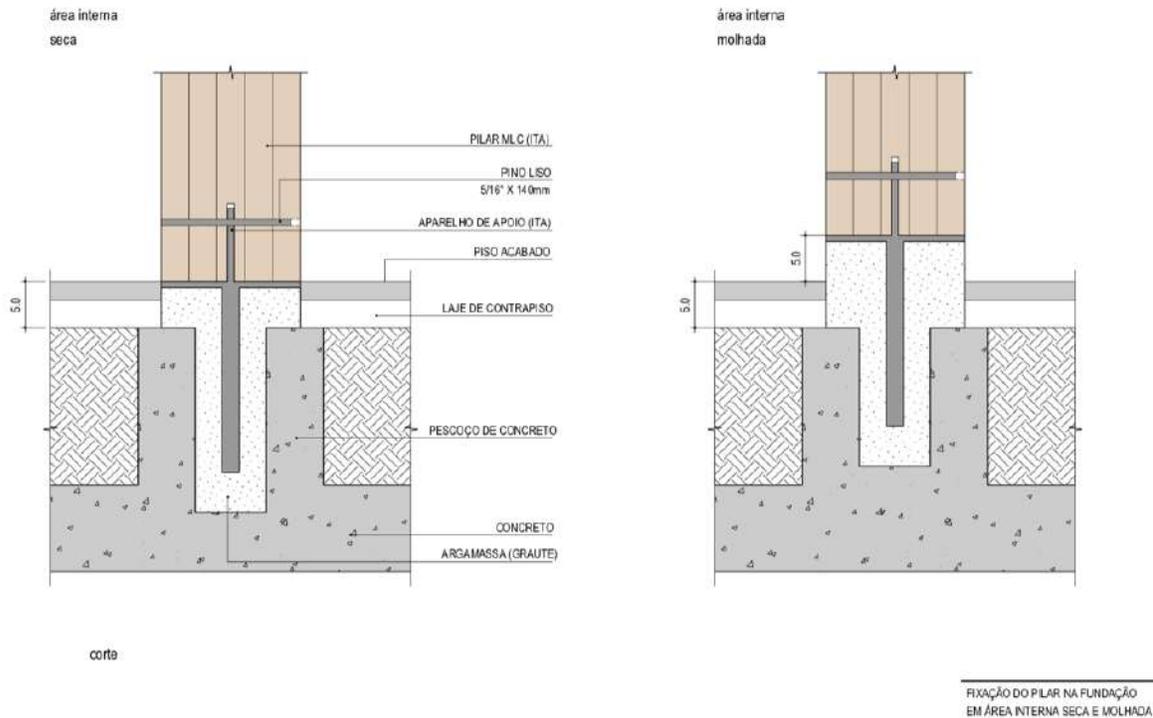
Detalhamento construtivo da fixação do pilar em MLC nas áreas secas e molhadas. (fonte: Ita Construtora)
